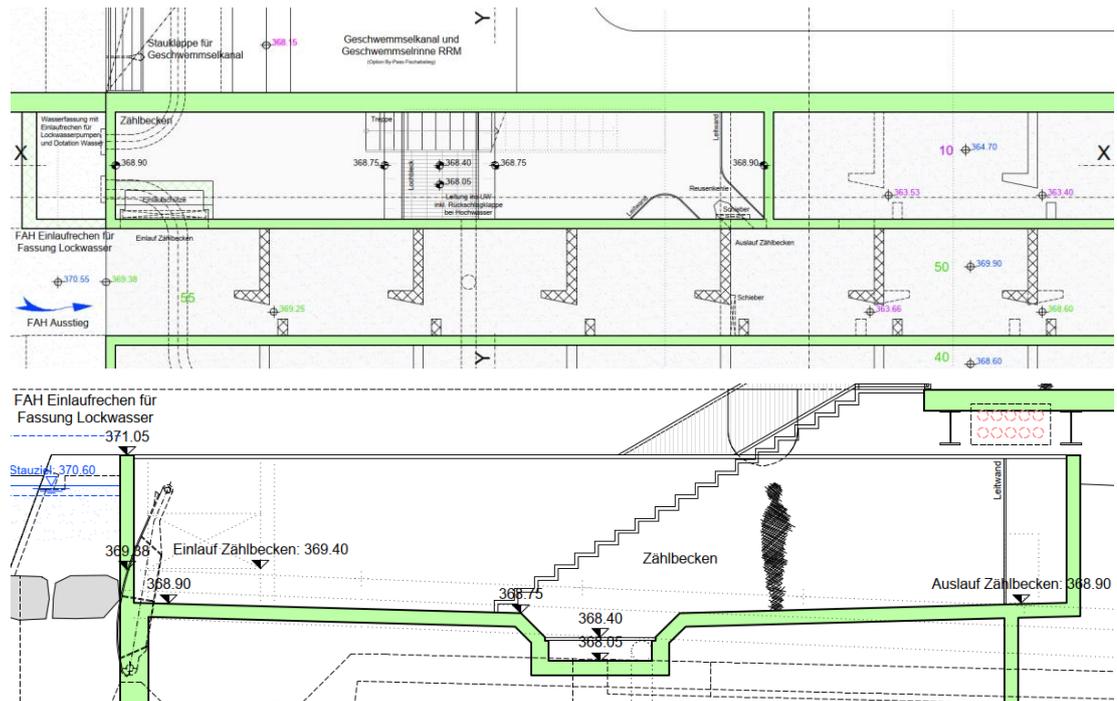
Fischzählbecken mit Kurzschliessen von drei Schlitzpassbecken (Auszug Plan P.33.990)
